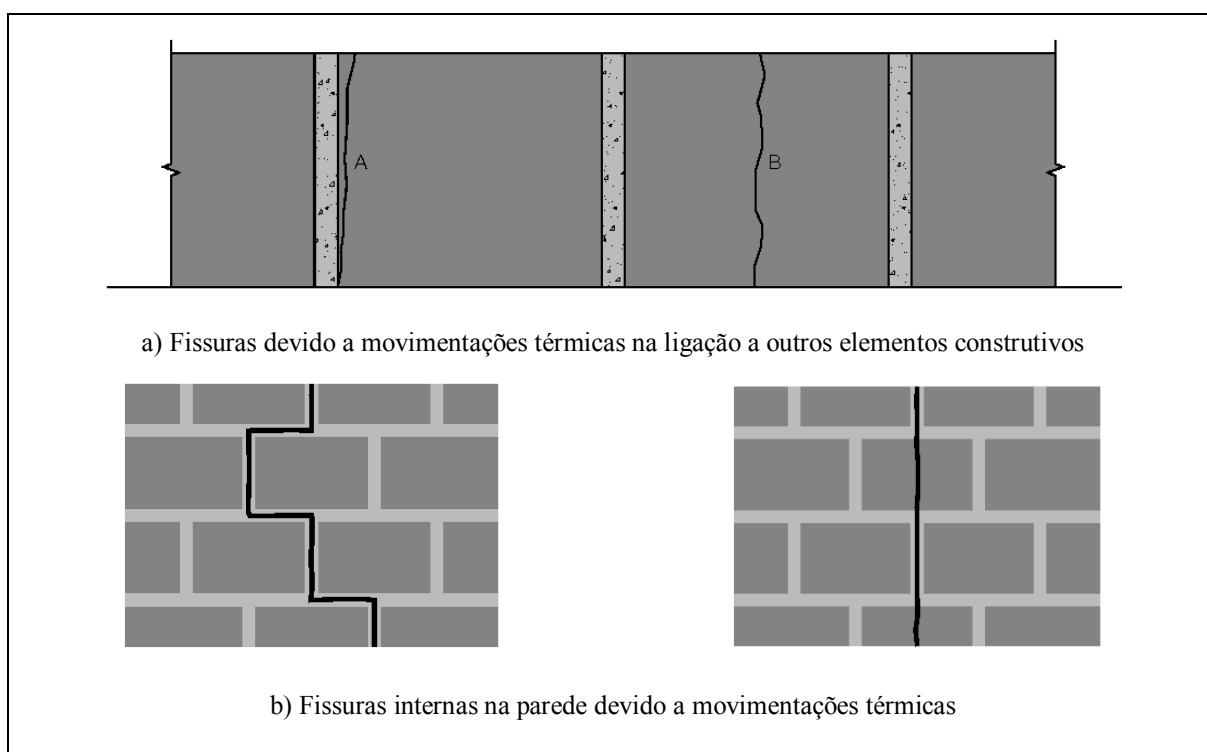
Fissuras devido a movimentações térmicas (PEREIRA, 2005)
